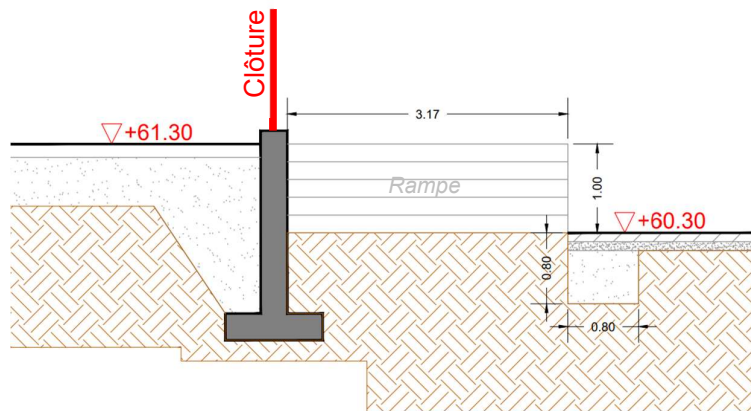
Coupe-type FF sur la zone 4 [R 3]
